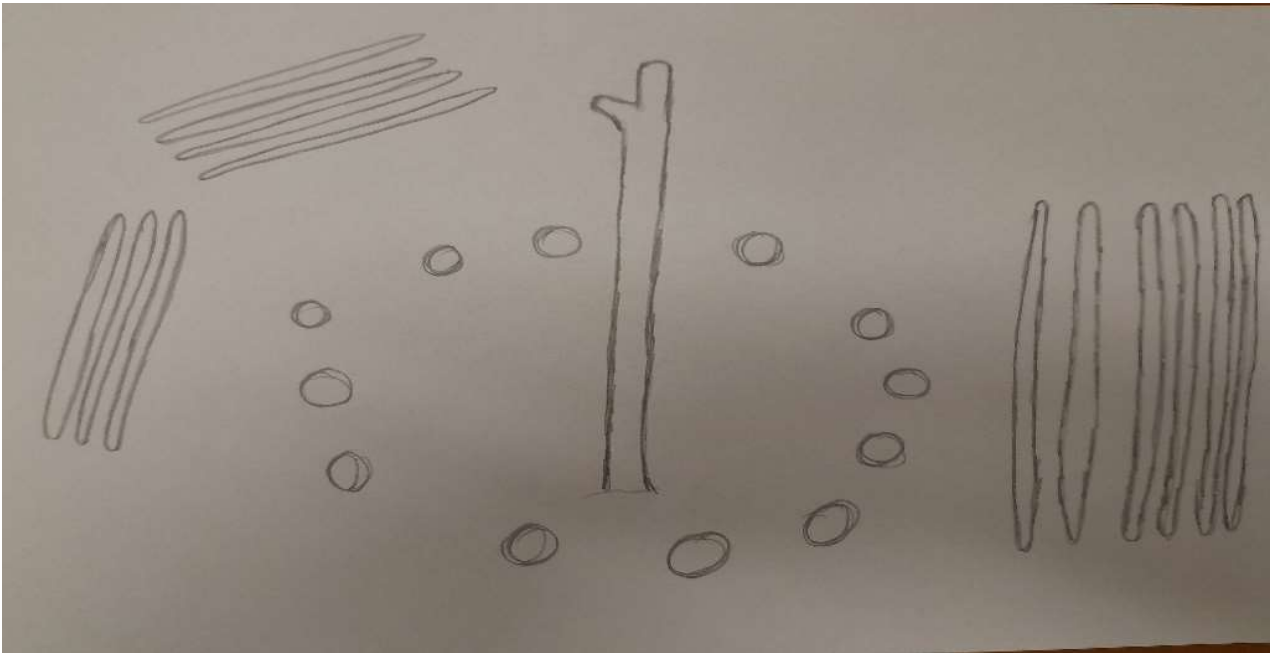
Primeiro passo para a construção da casa tradicional 'riuptabire: colocação da *tsihuiwede* Fonte: Ilustração do autor
